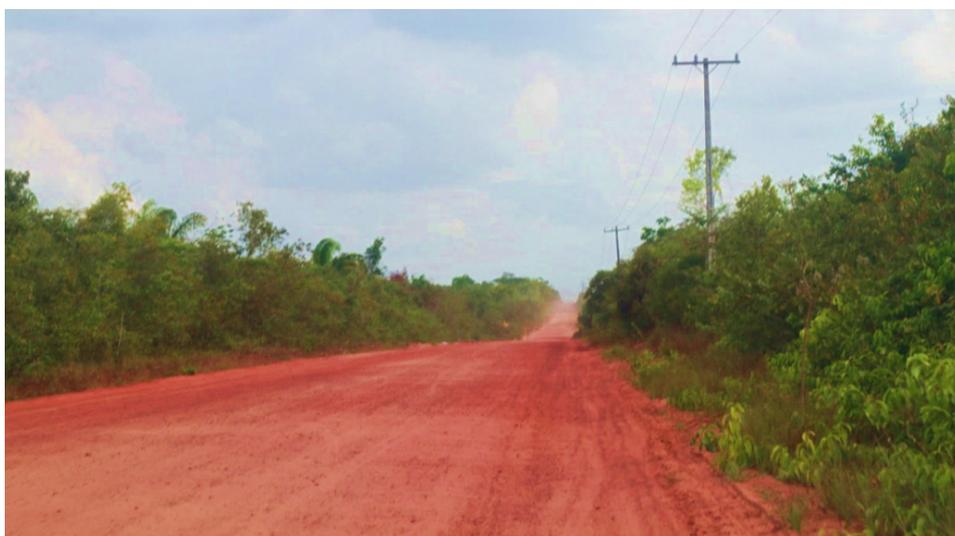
Estrada PA que liga Marapanim à Vila Silva
